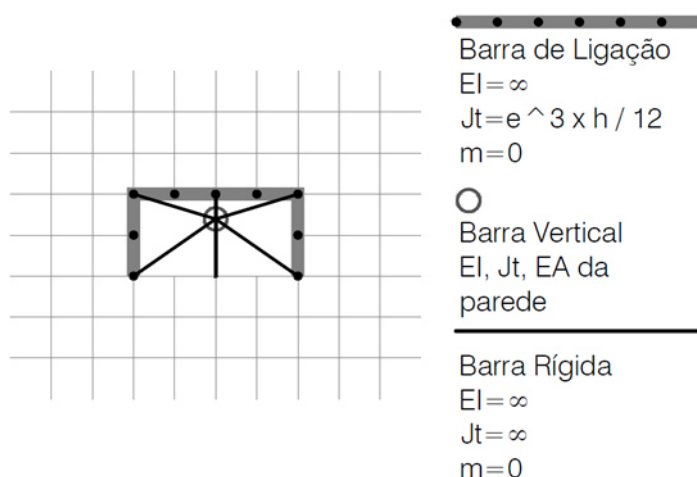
Modelação da ligação do núcleo à laje (e =espessura da parede, h =altura entre pisos)
